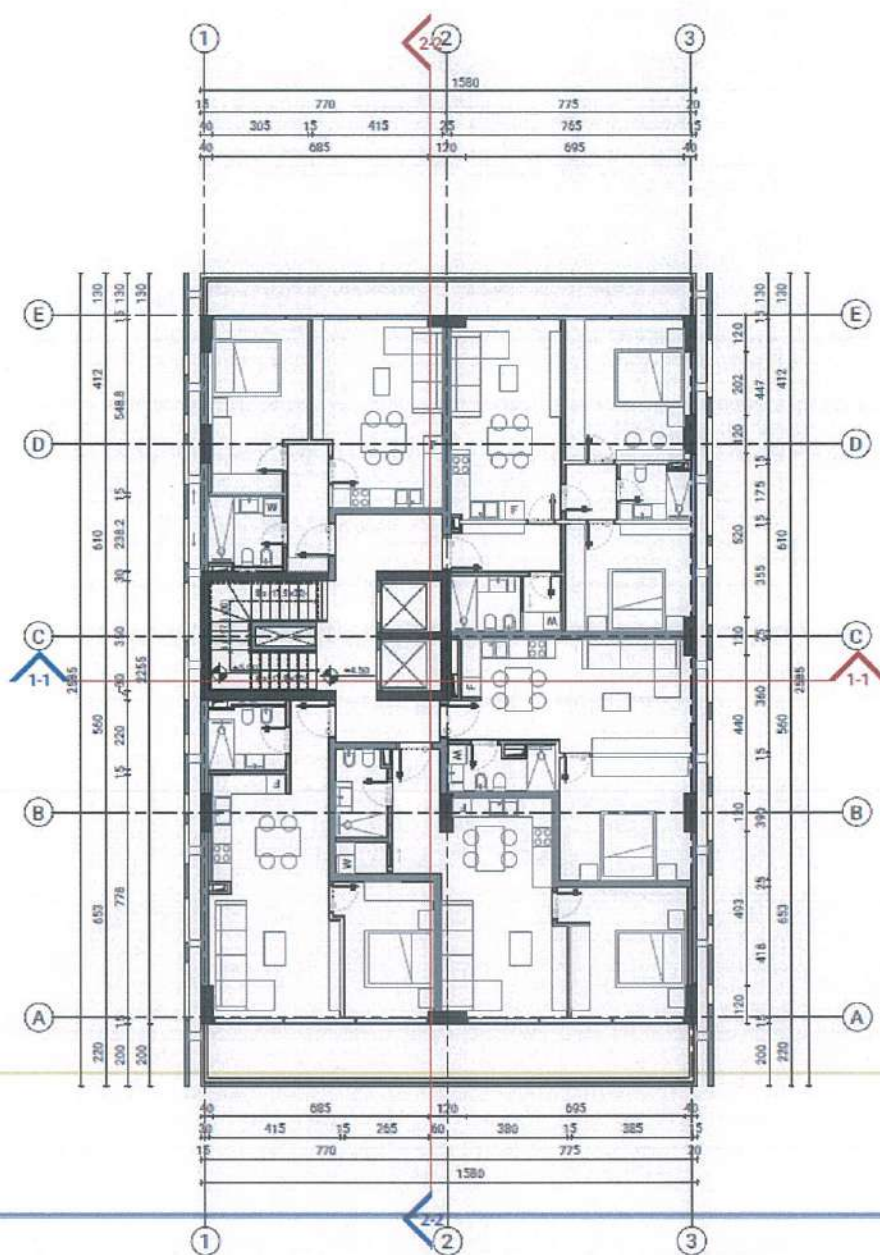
Planimetria e katit Tip, Kati 1 - Kati 8
